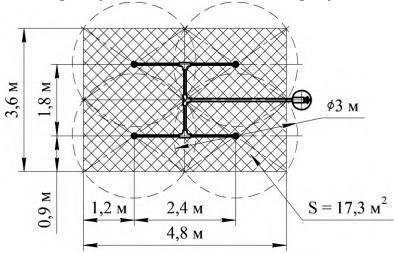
Вариант трубной разводки по вписанным прямоугольникам на 4 насадка-распылителя
